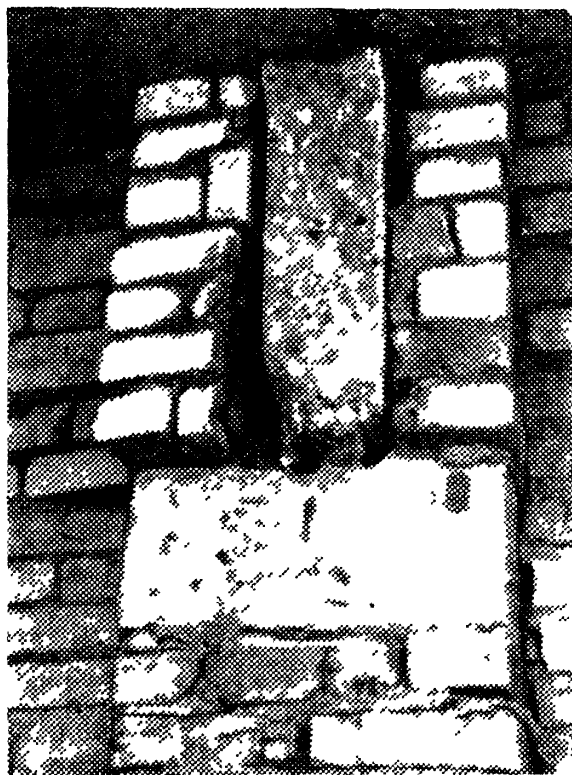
Разрушение железобетонной балки (видны остатки бетона в стене)
